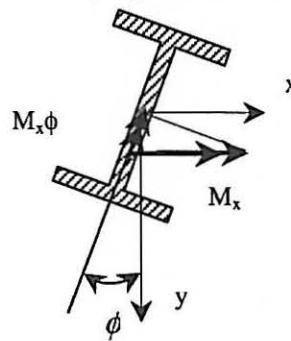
Justificação do aparecimento do momento fora do plano de flexão
